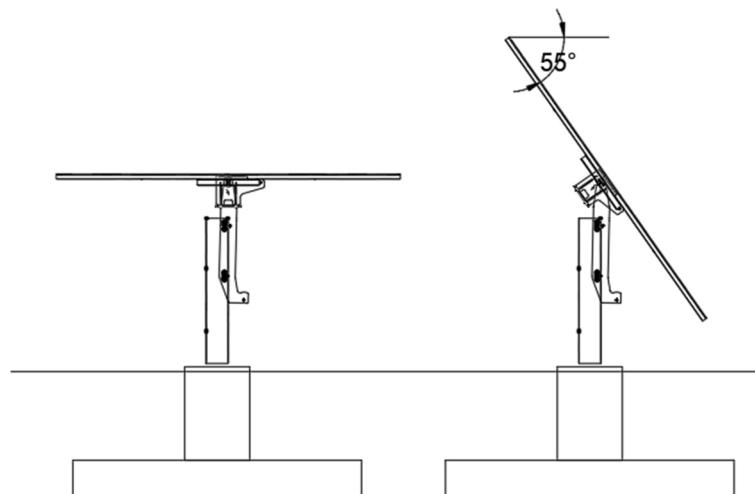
Configurazione di Stow per il vento (Sx) e di massima inclinazione (Dx)
